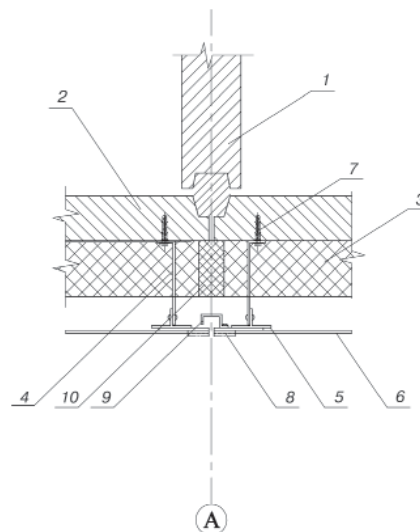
Вертикальный стык панелей наружных стен с НФС ВВЗ: 1 – внутренняя стена; 2 – панель наружной стены; 3 – утеплитель; 4 – кронштейн; 5 – вертикальный профиль; 6 – облицовочная плитка; 7 – анкерный дюбель; 8 – кляммер; 9 – вертикальный желоб; 10 – упругая минераловатная вставка
